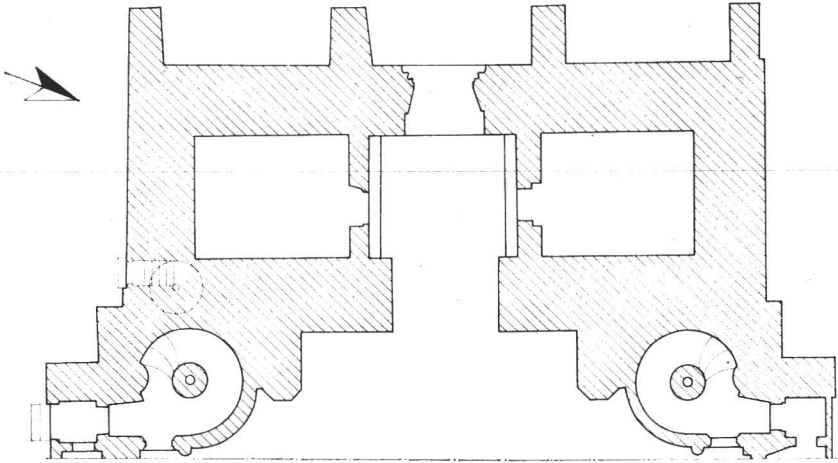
Grundriß der Blauen Türme der Marktkirche Halle
